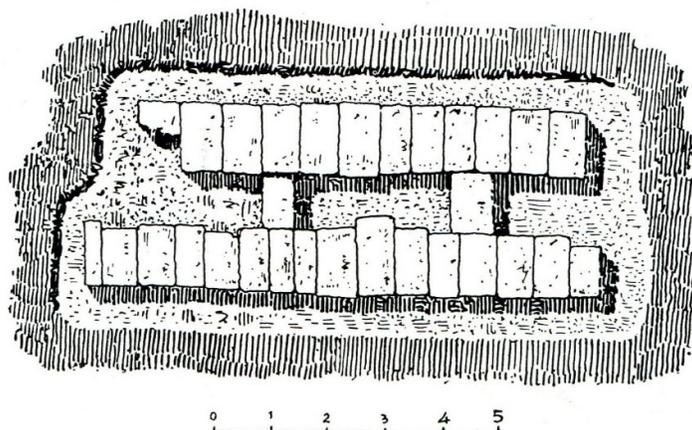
Rilievo planimetrico della fondazione di parte dell'antemurale del Fusco, fatto dall'Orsi.
